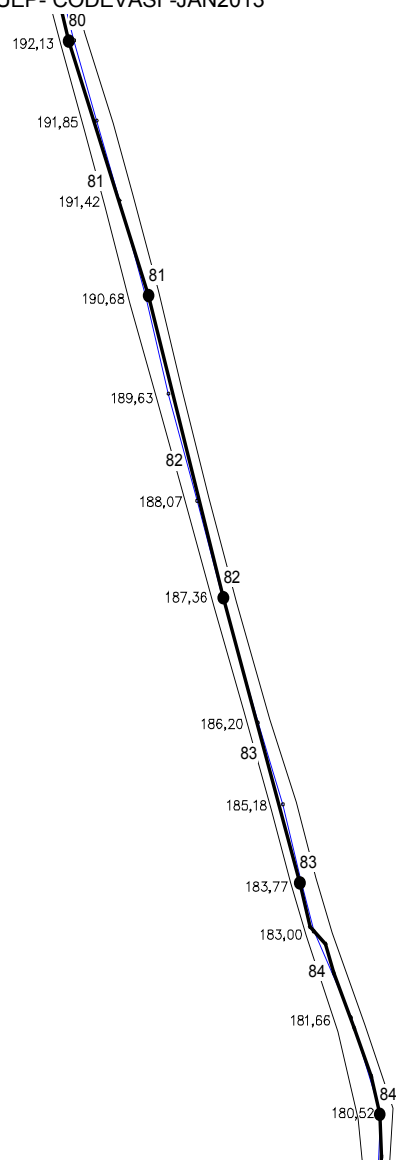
EPANET parcial 8 – Rede de Lajes 2
